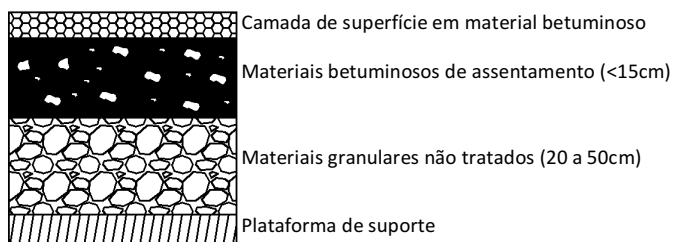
Estrutura de pavimento tipo *chaussée souple* (LCPC/SETRA, 1994)..
